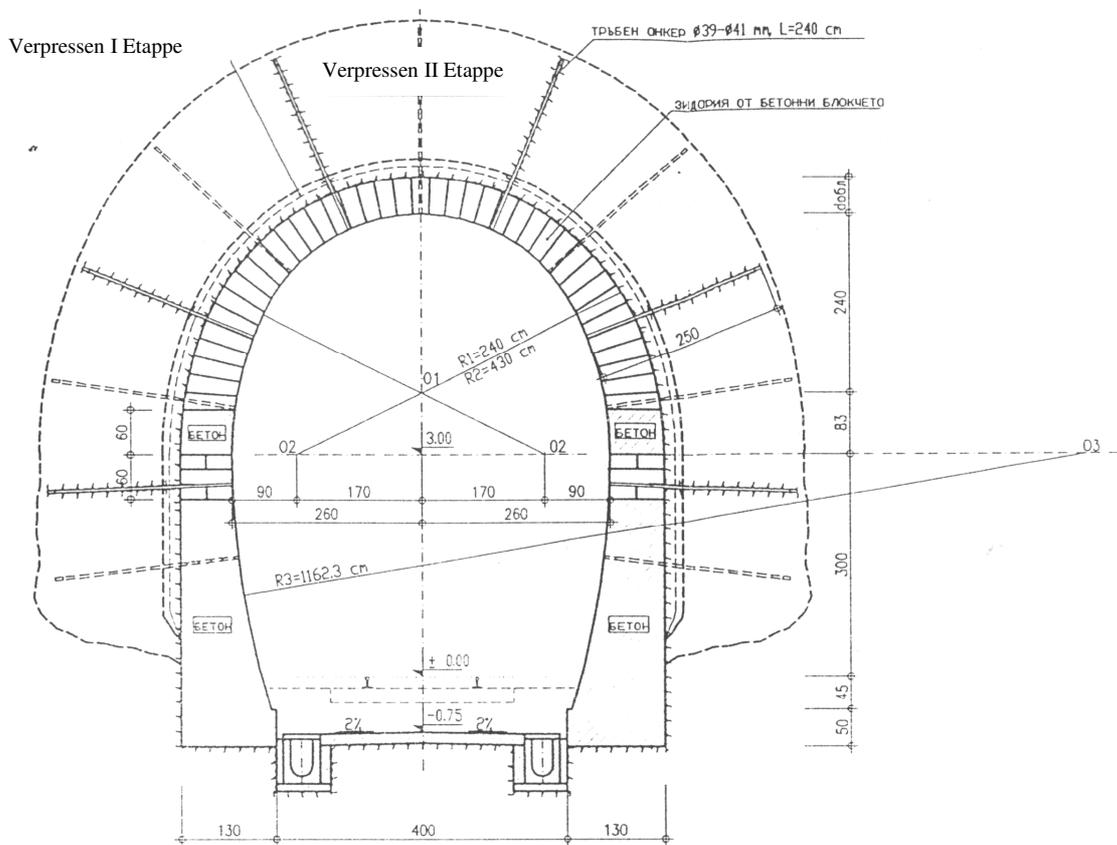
Typenquerschnitt ohne Hydroisolation, Sicherung des existierenden Tunnelausbaus
